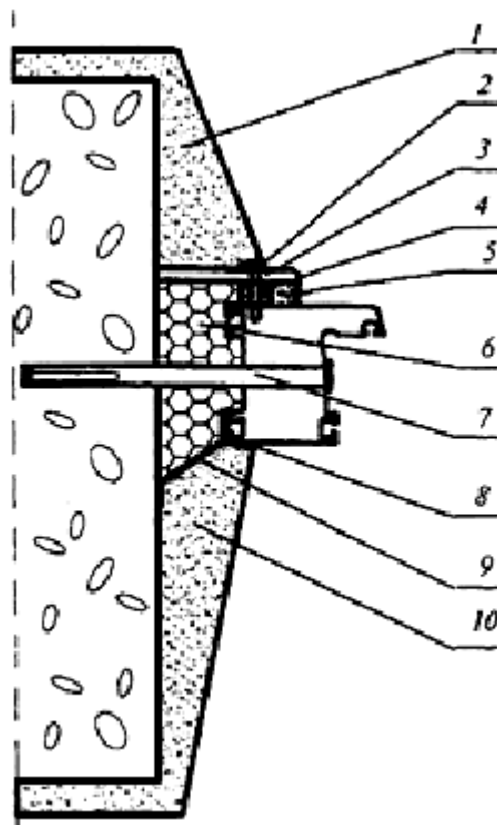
Узел бокового примыкания оконного блока к проему без четверти в стене из ячеистобетонных блоков с отделкой фасада, наружных и внутренних откосов штукатурным раствором:
